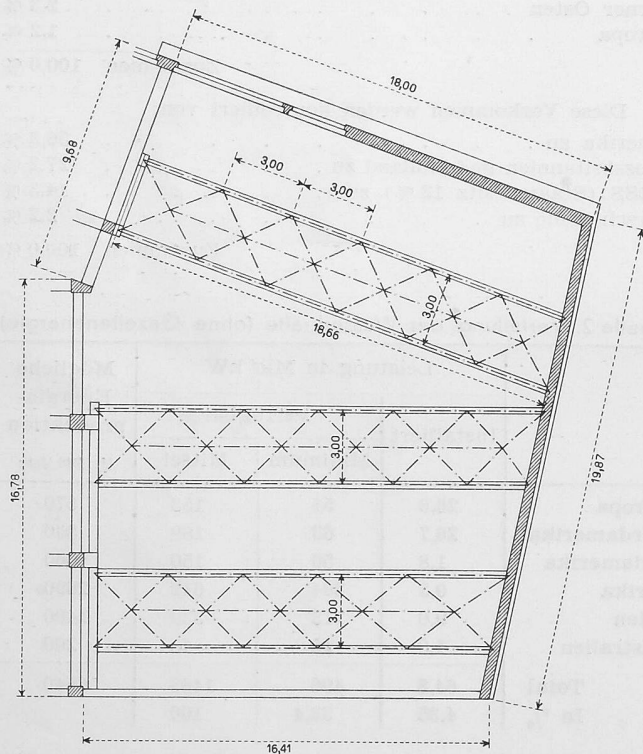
Untersicht des Daches mit System der Fachwerkträger, Masstab 1 : 300
